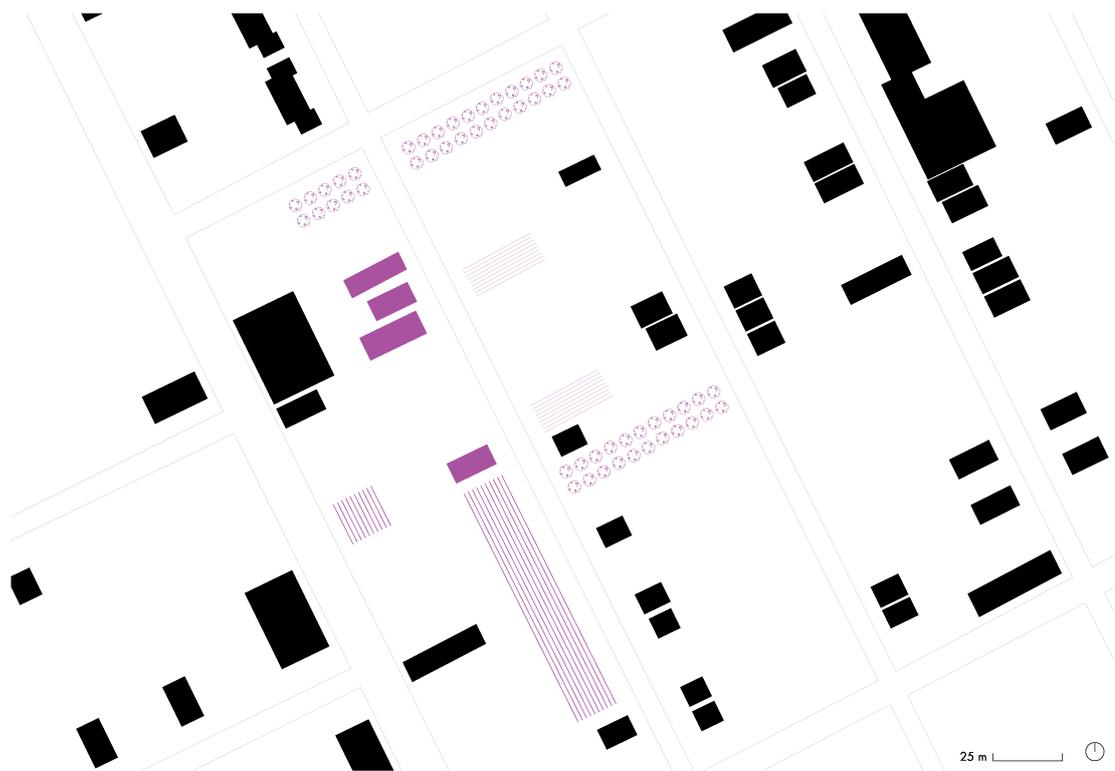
Lageplan der Oakland Avenue Urban Farm.
